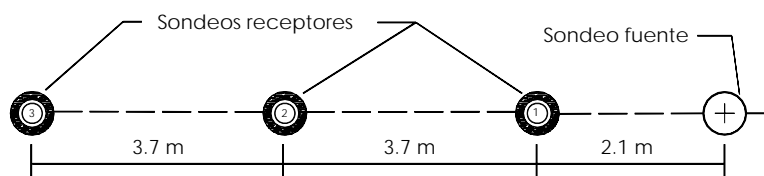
Vista en planta (Hoar y Stokoe, 1978).
